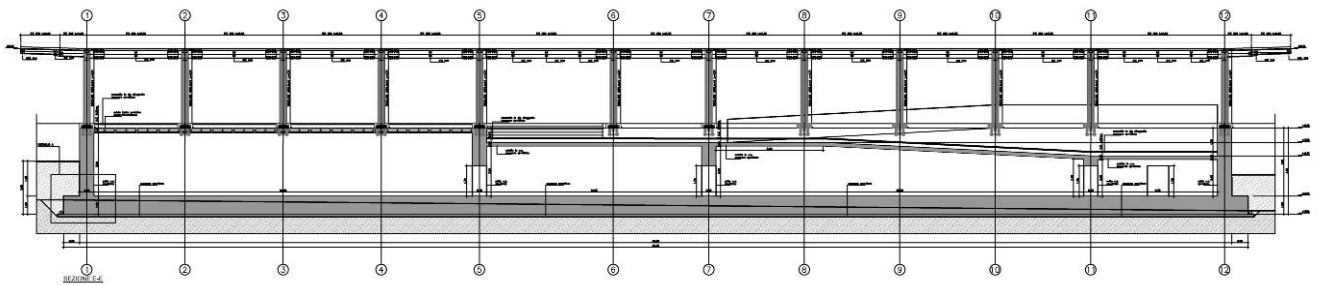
Sezione longitudinale tipo dell'edificio fermata
